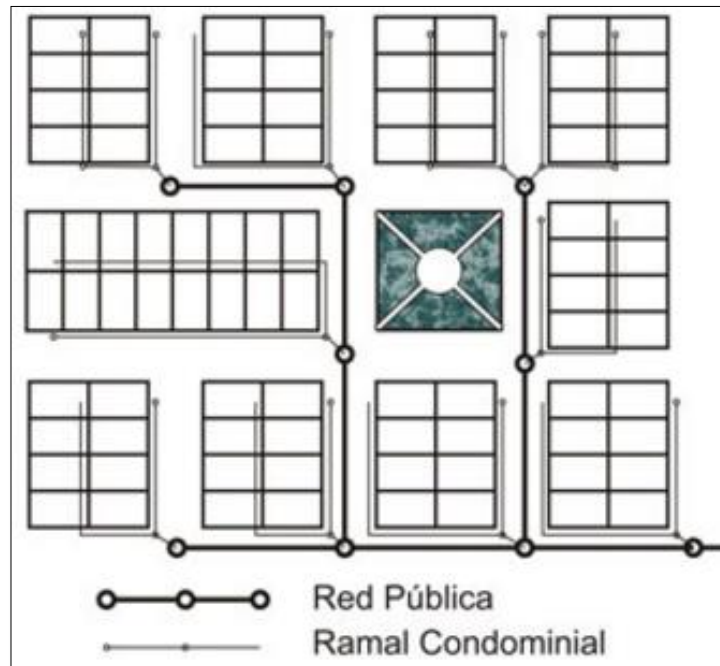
Ubicación de la Red de Sistema de Alcantarillado
